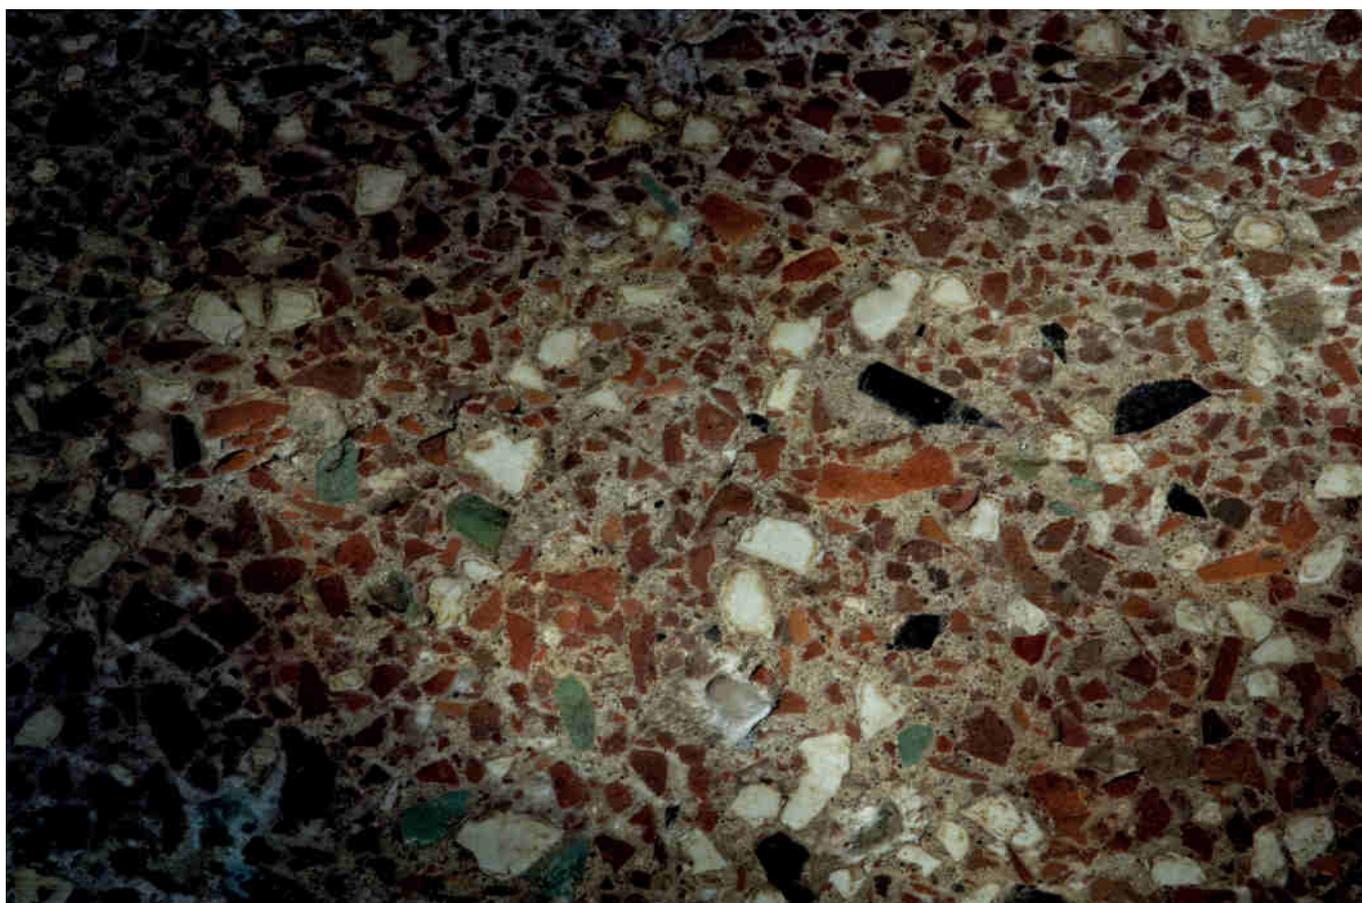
Ambiente TT, particolare del pavimento in battuto con scaglie multicolori.
